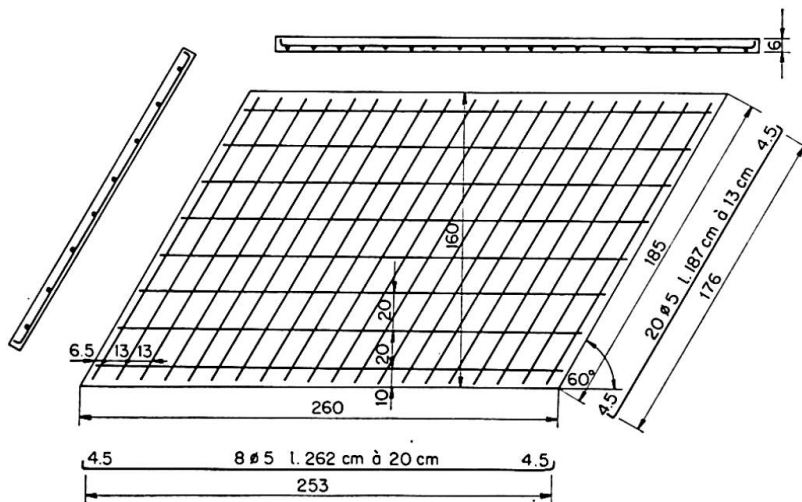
Plan et coupes des dalles d'essai avec les armatures.
